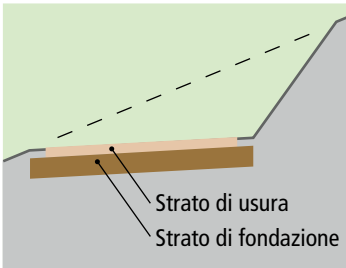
Sezione tipo di un sentiero con strato di fondazione
